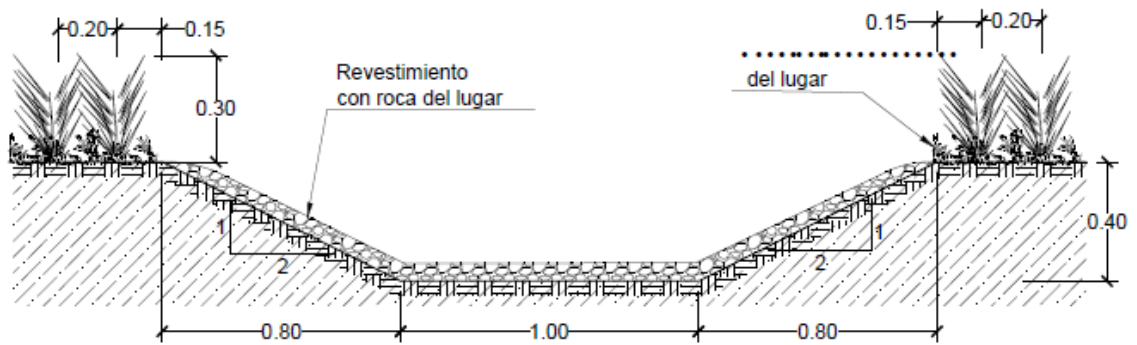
Detalle típico Canal de Descarga C-4 (sin escala)
